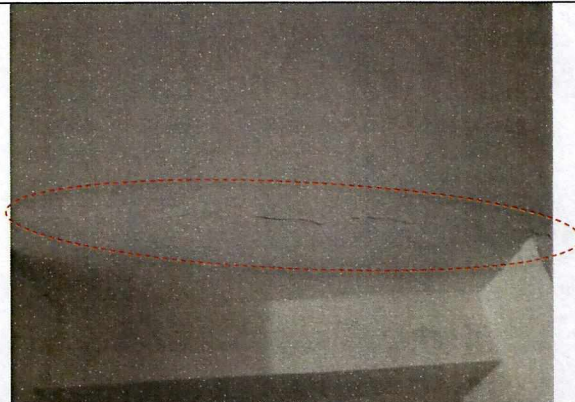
Afectación en el muro perimetral – costado noroccidental, (afectación vista desde el interior).
